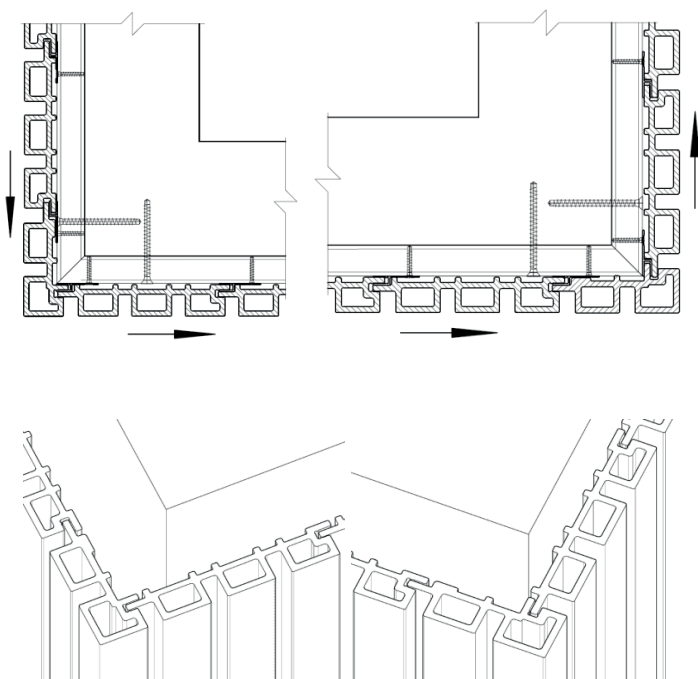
Instalación de la fachada en la esquina exterior del edificio. Nodo 3 y 4
